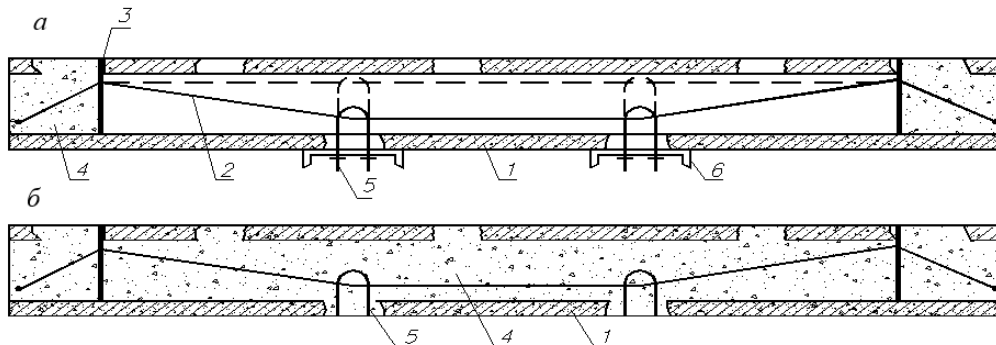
Усиление сборных многопустотных плит предварительно напряженной арматурой:
